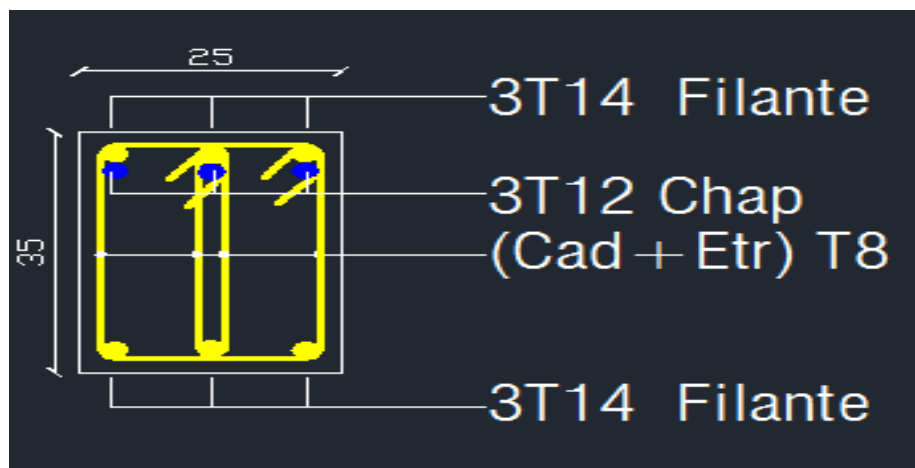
Ferrailage sur appuis d'une poutre principale
